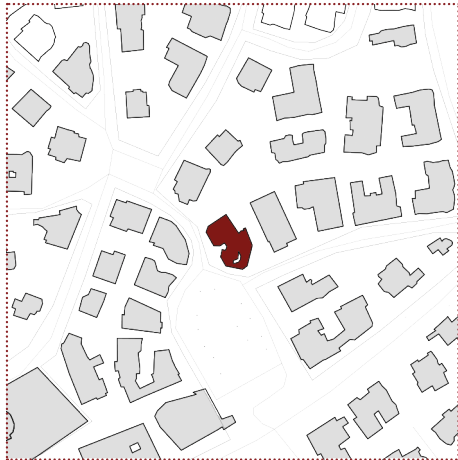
Plano emplazamiento. E. 1:5000. *Elaboración propia.
